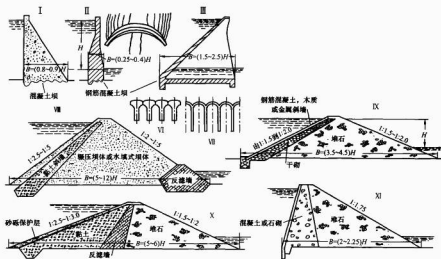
混凝土、钢筋混凝土及混合式坝的结构简图
